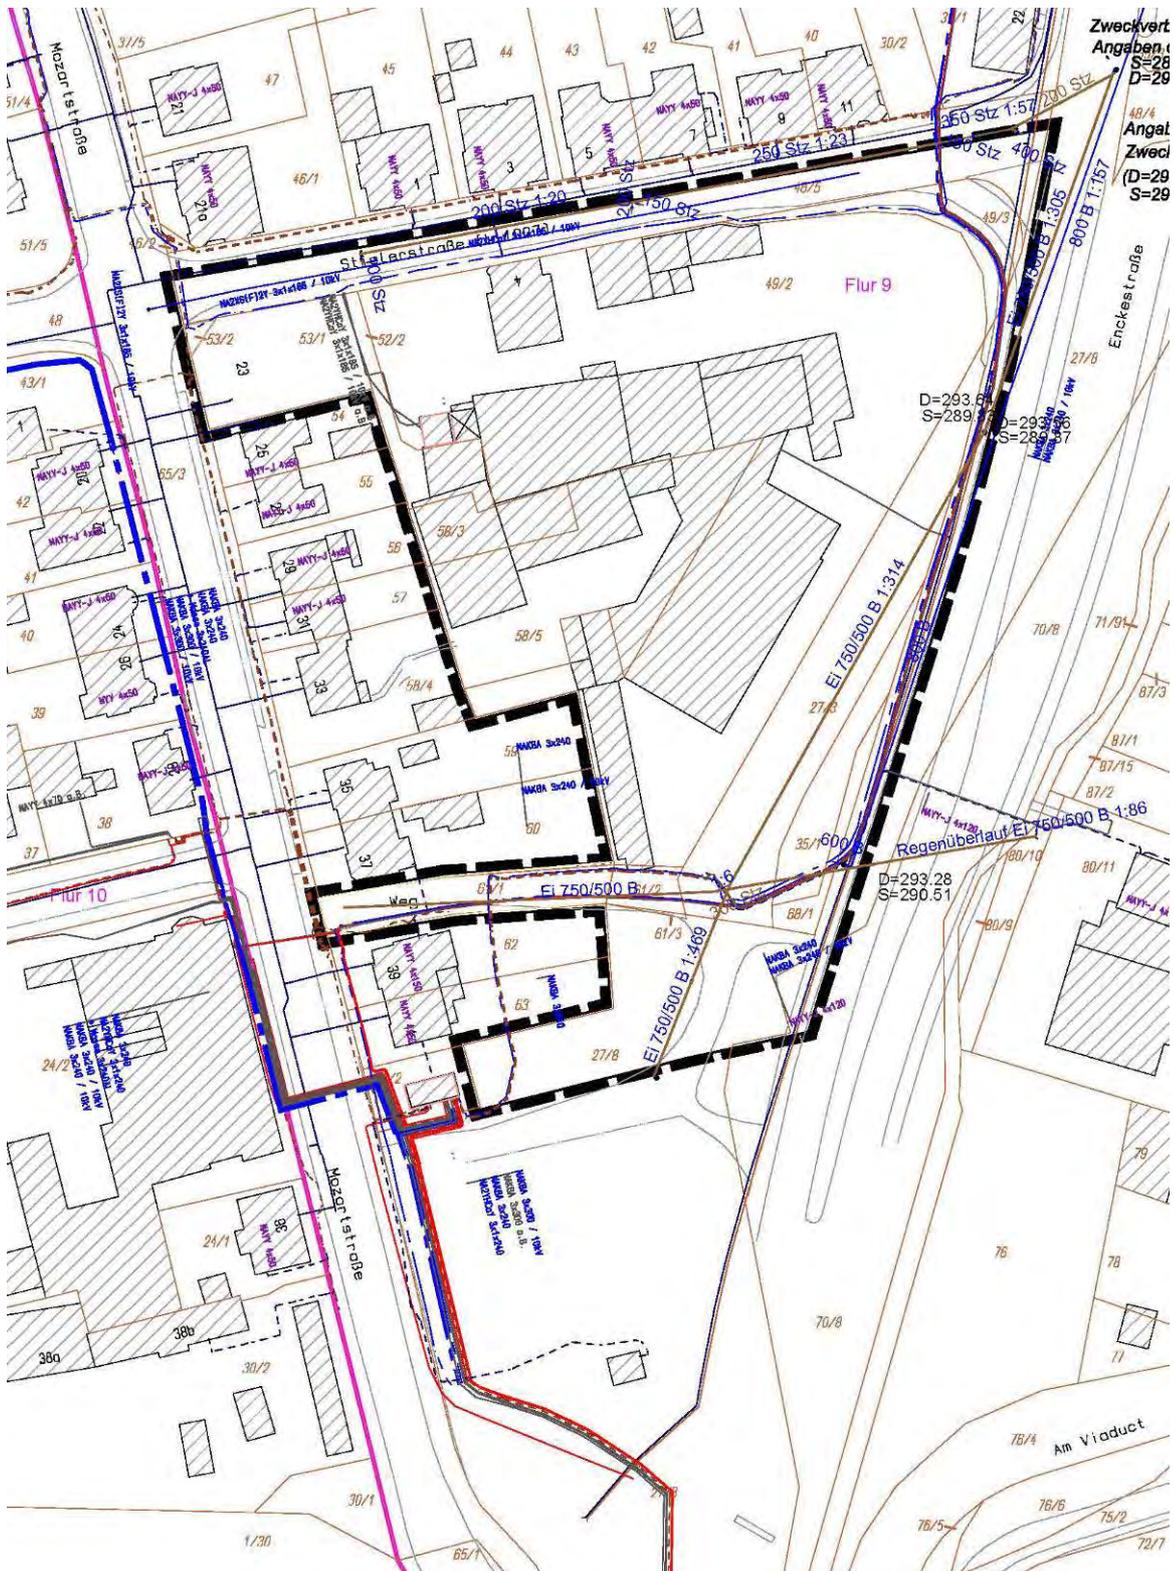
Lageplan mit Leitungsbestand und Bestandsgebäuden
